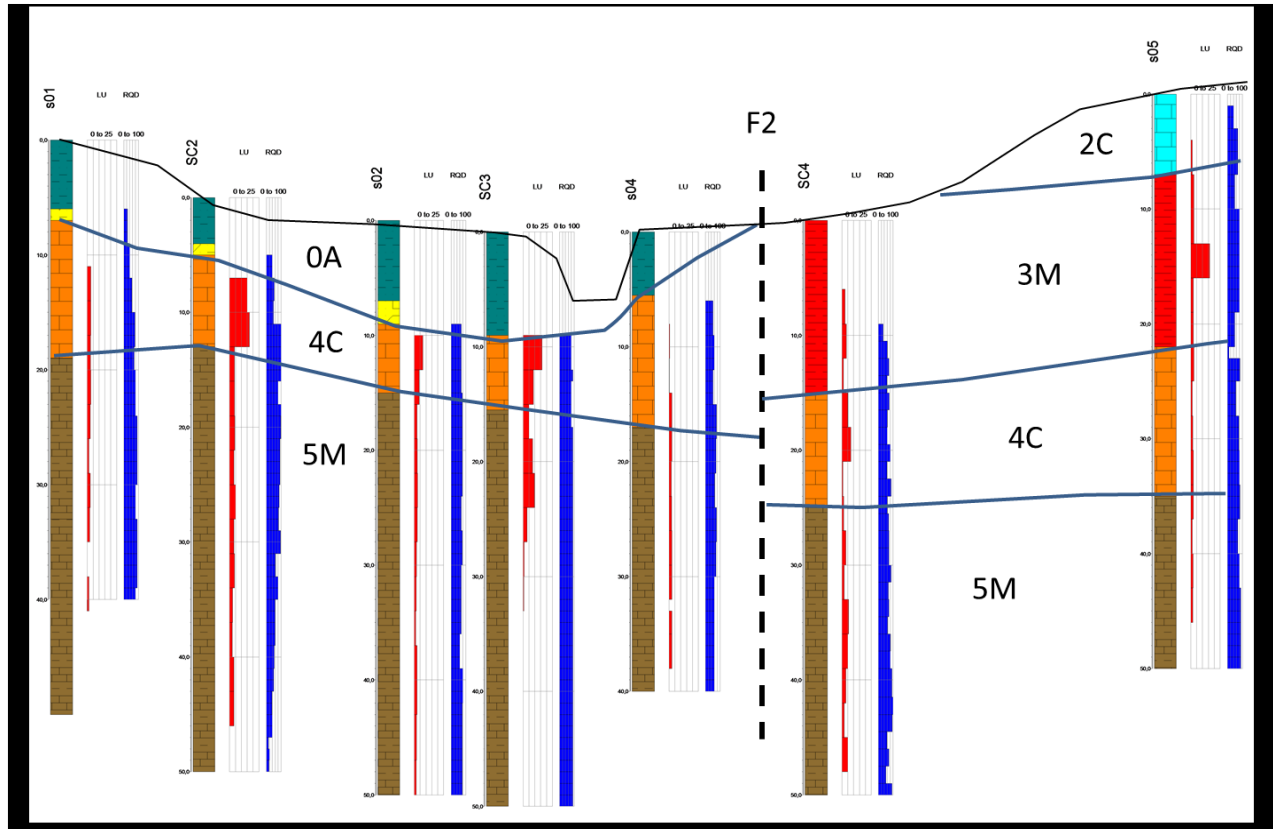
Coupe AA, rive gauche-rive droite à limite amont du futur ouvrage en béton
